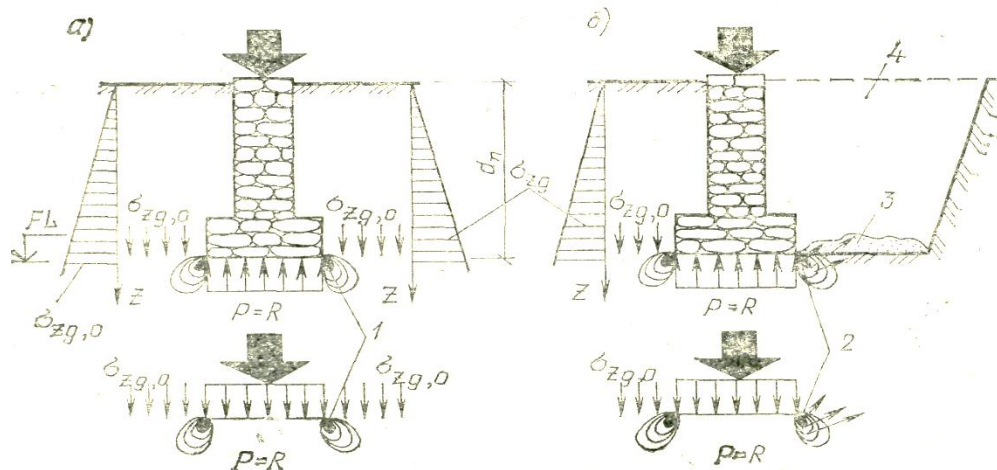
Вертикальні напруження в основі фундаментів: *a* – до розробки сусіднього котловану; *б* – після його розробки; 1 – зони пластичної деформації ґрунту; 2 – зони можливого випирання ґрунту; 3 – підйом дна котловану; 4 – котлован, влаштований біля фундаменту
